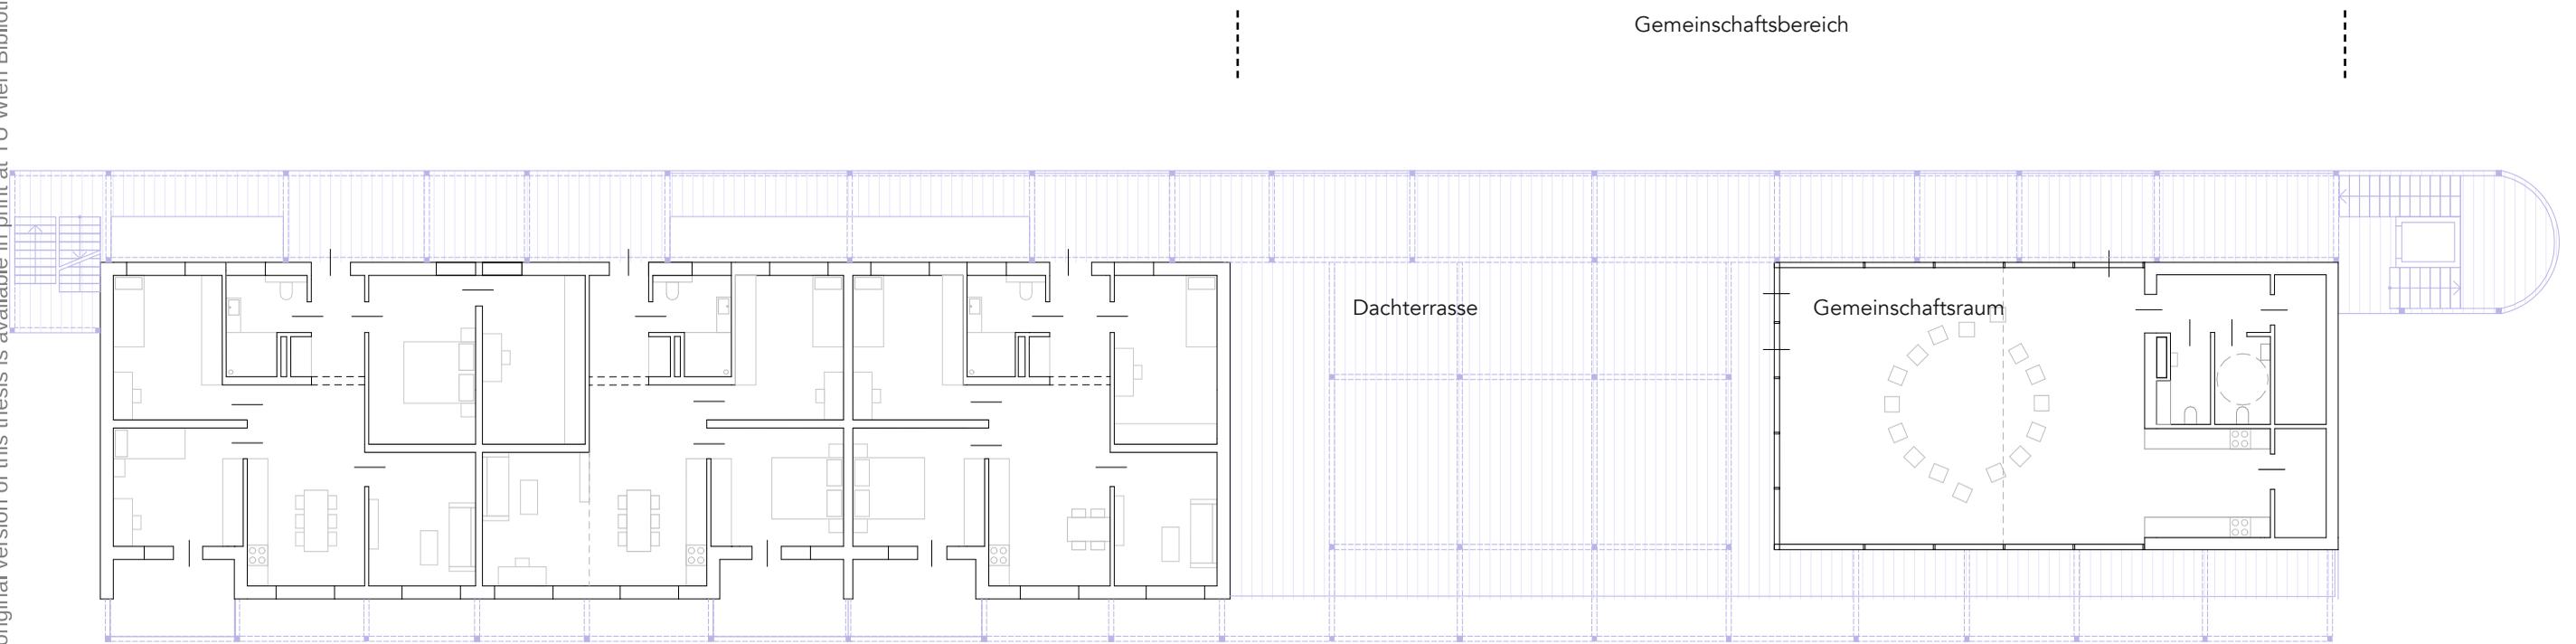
Grundriss Aufstockung M 1:200
